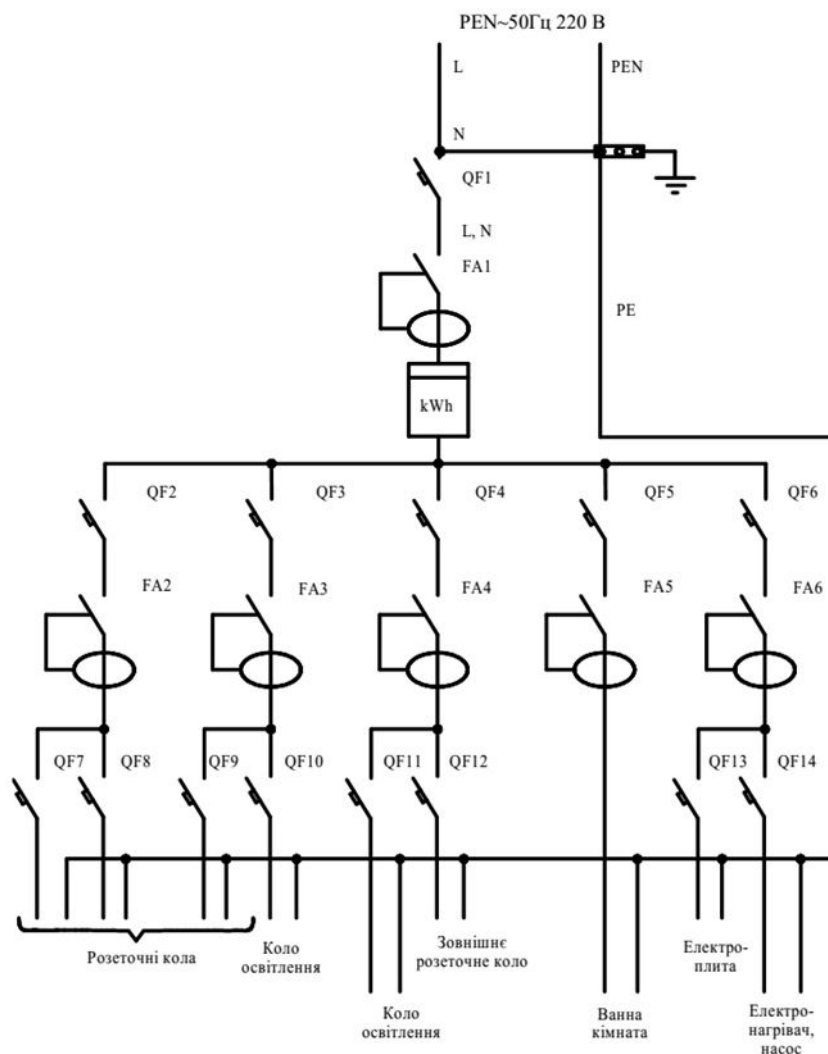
Схема електропостачання будівлі з системою TN-C-S
